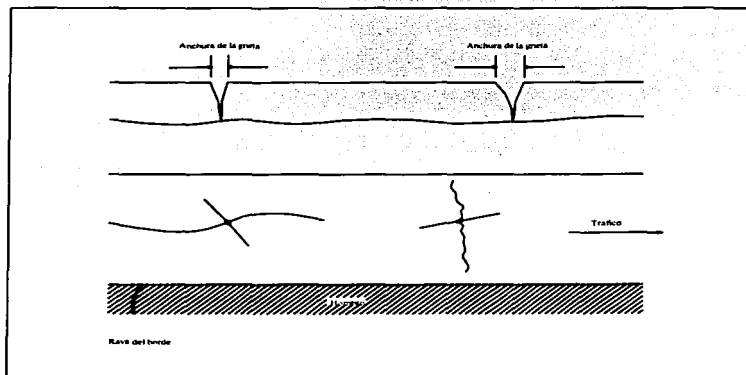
Mediciones de anchos de grietas sobre superficies de pavimentos de concreto asfáltico.
